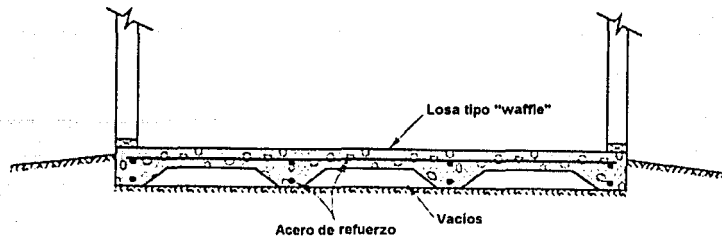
Losa de cimentación reforzada tipo "waffle"
